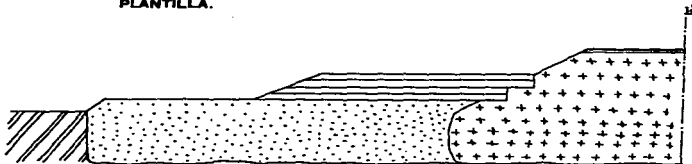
Procedimiento de construcción utilizando geotextiles
